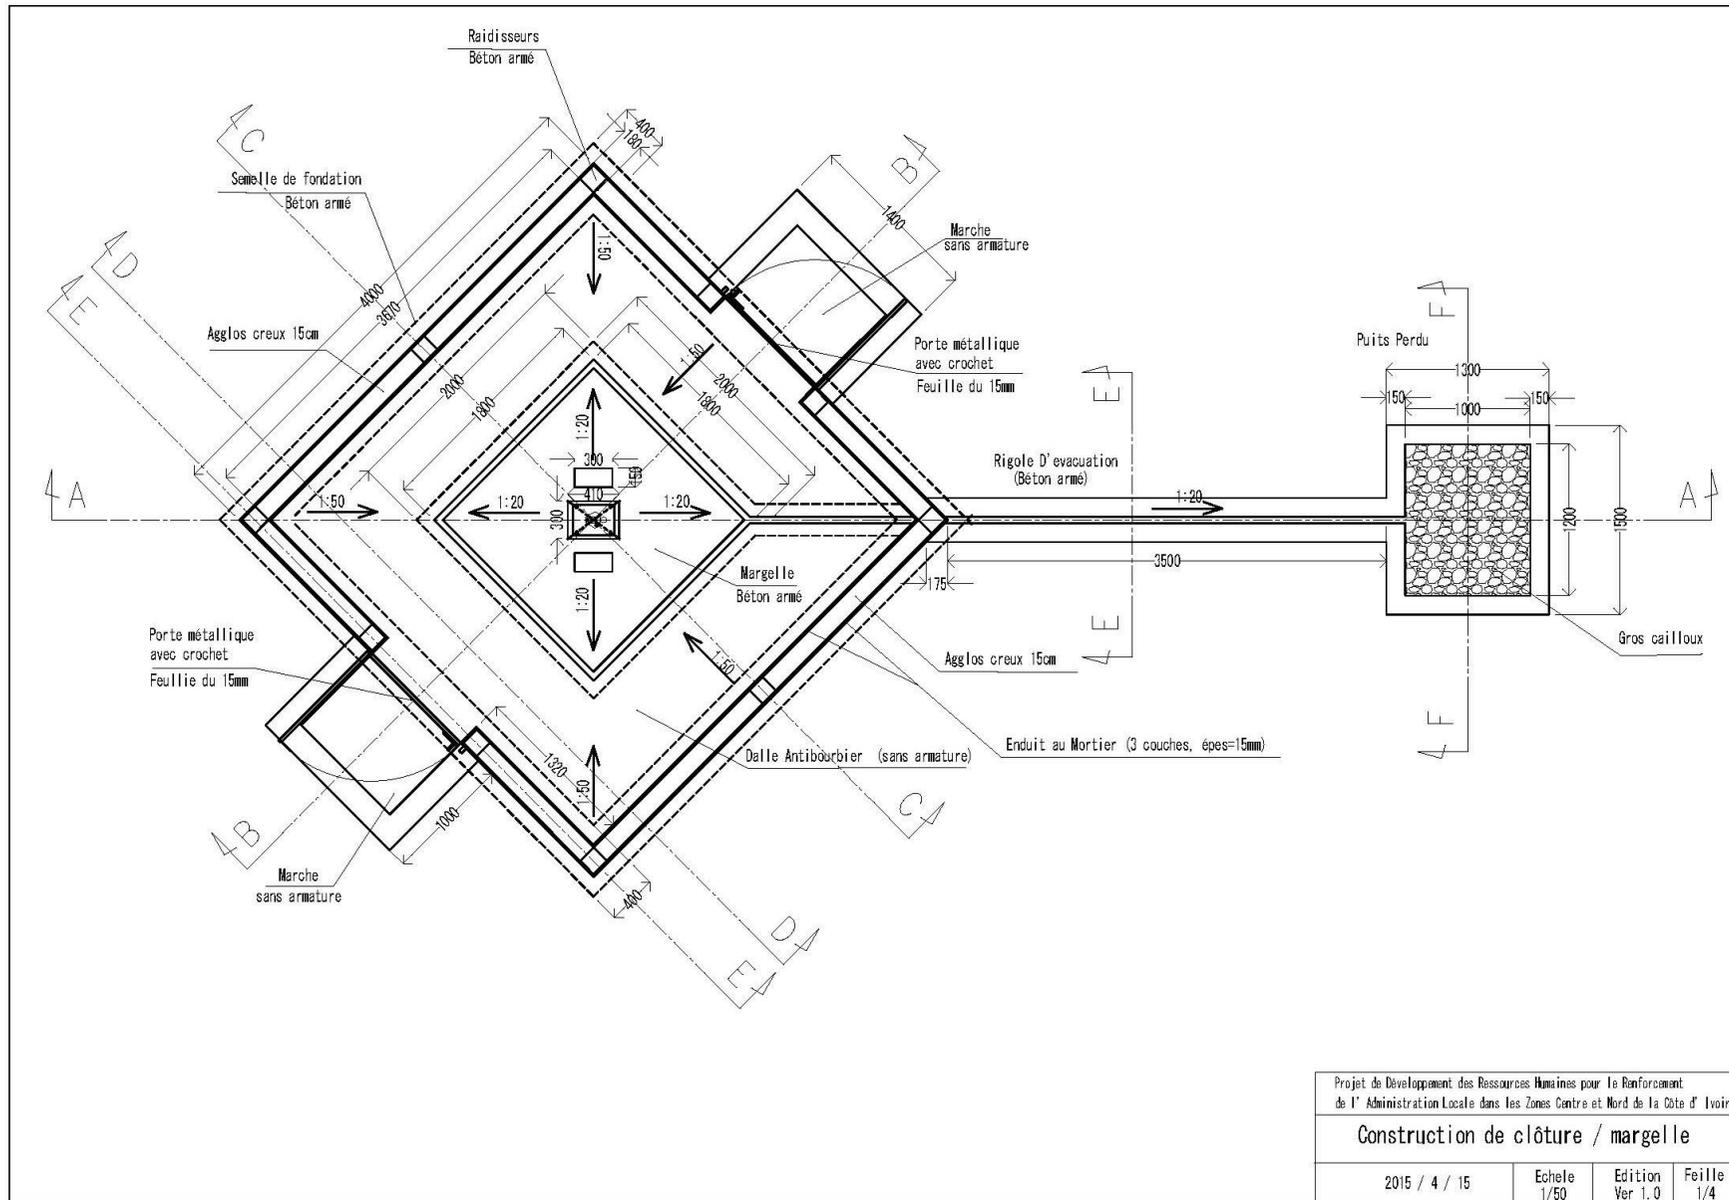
Plan de la superstructure d'une PMH (1/4)
